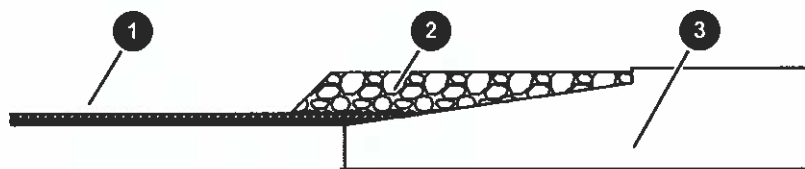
Fundament Teilanschüttung mit Erdauflast
